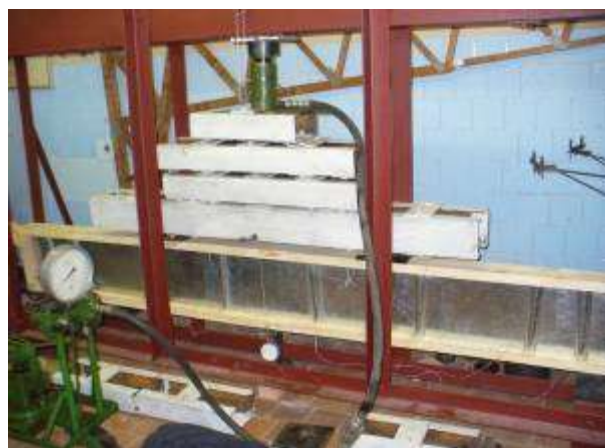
Опытный образец балки с полуцилиндрическими гофрами в процессе испытания
